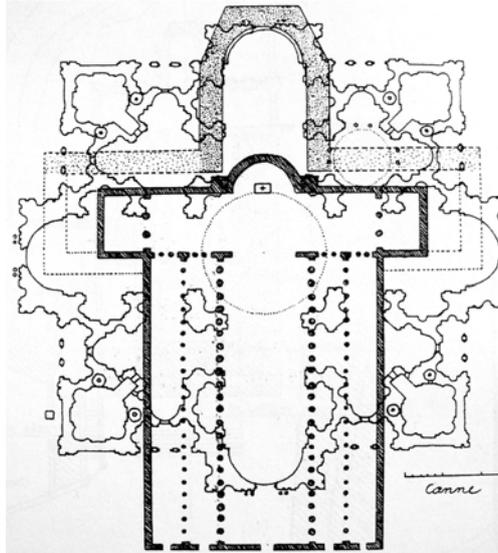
Grundriss von Alt-St. Peter mit fetten Linien gekennzeichnet. Der Neubau ist durch die mageren Grundrisszeichnungen kenntlich gemacht. Rekonstruktion nach Wolf-Metternich 1955. 2
